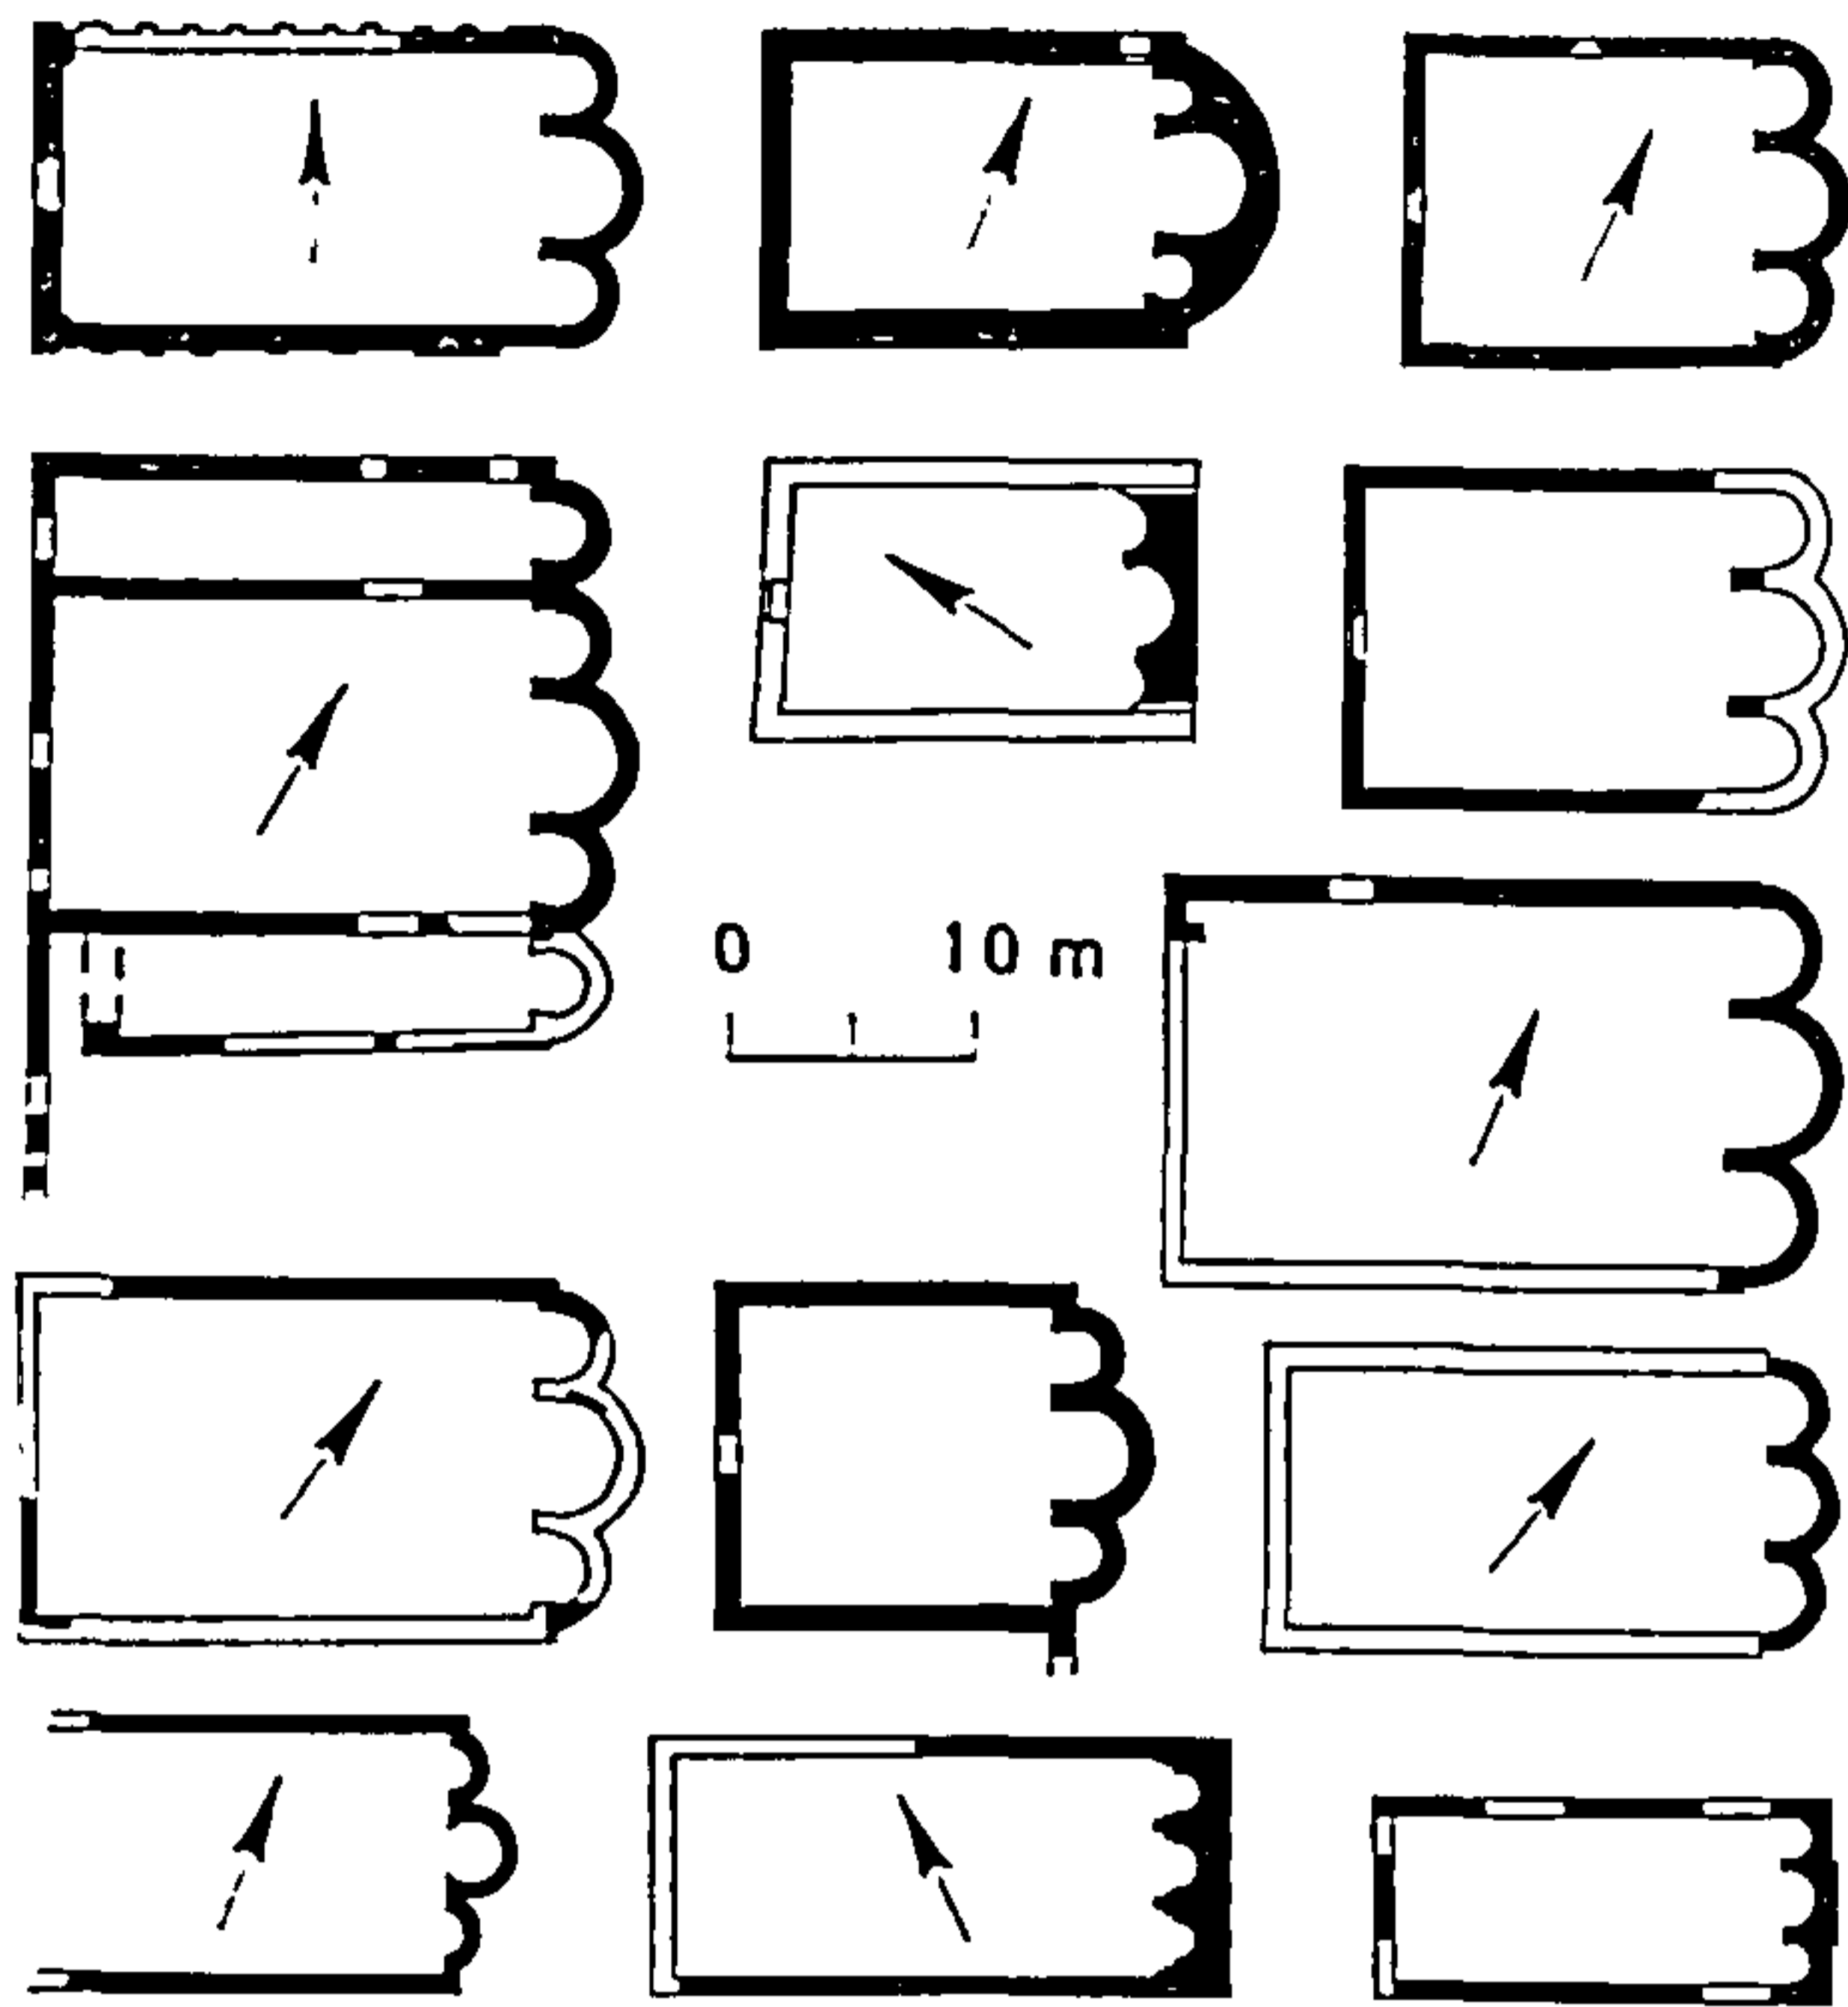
Dreiapsidensäle, Grundrisse. Maßstab 1:1000.
